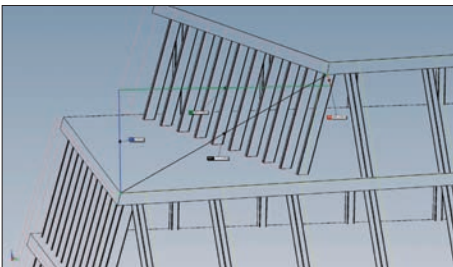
Printscreen 3D-Viewer - Ausmass Tool
